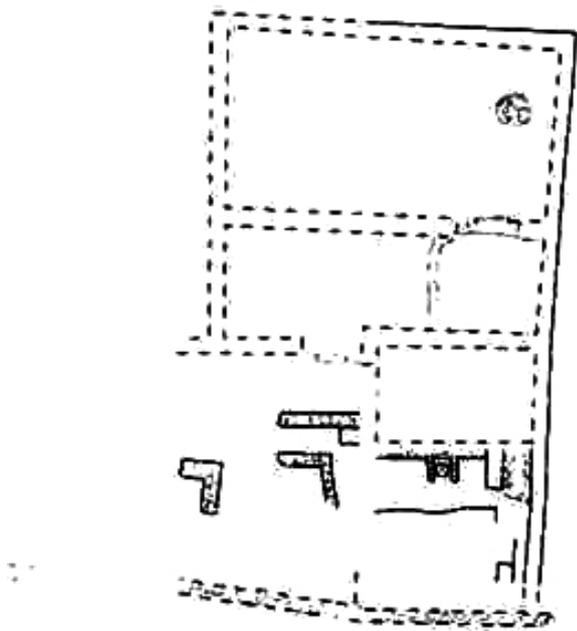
Durrës, sito 206 . Planimetria seconda fase [aut. DAD 2007]
